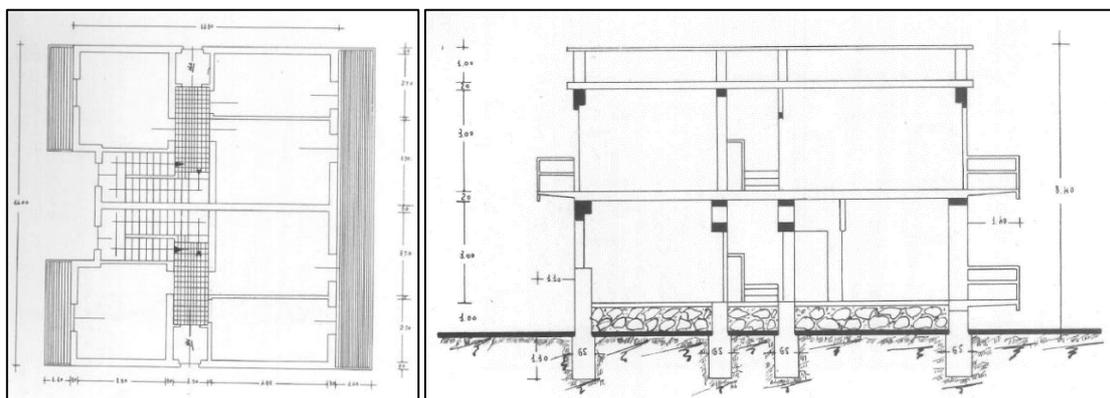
Pianta e sezione di un fabbricato tipo della tipologia MUR1
